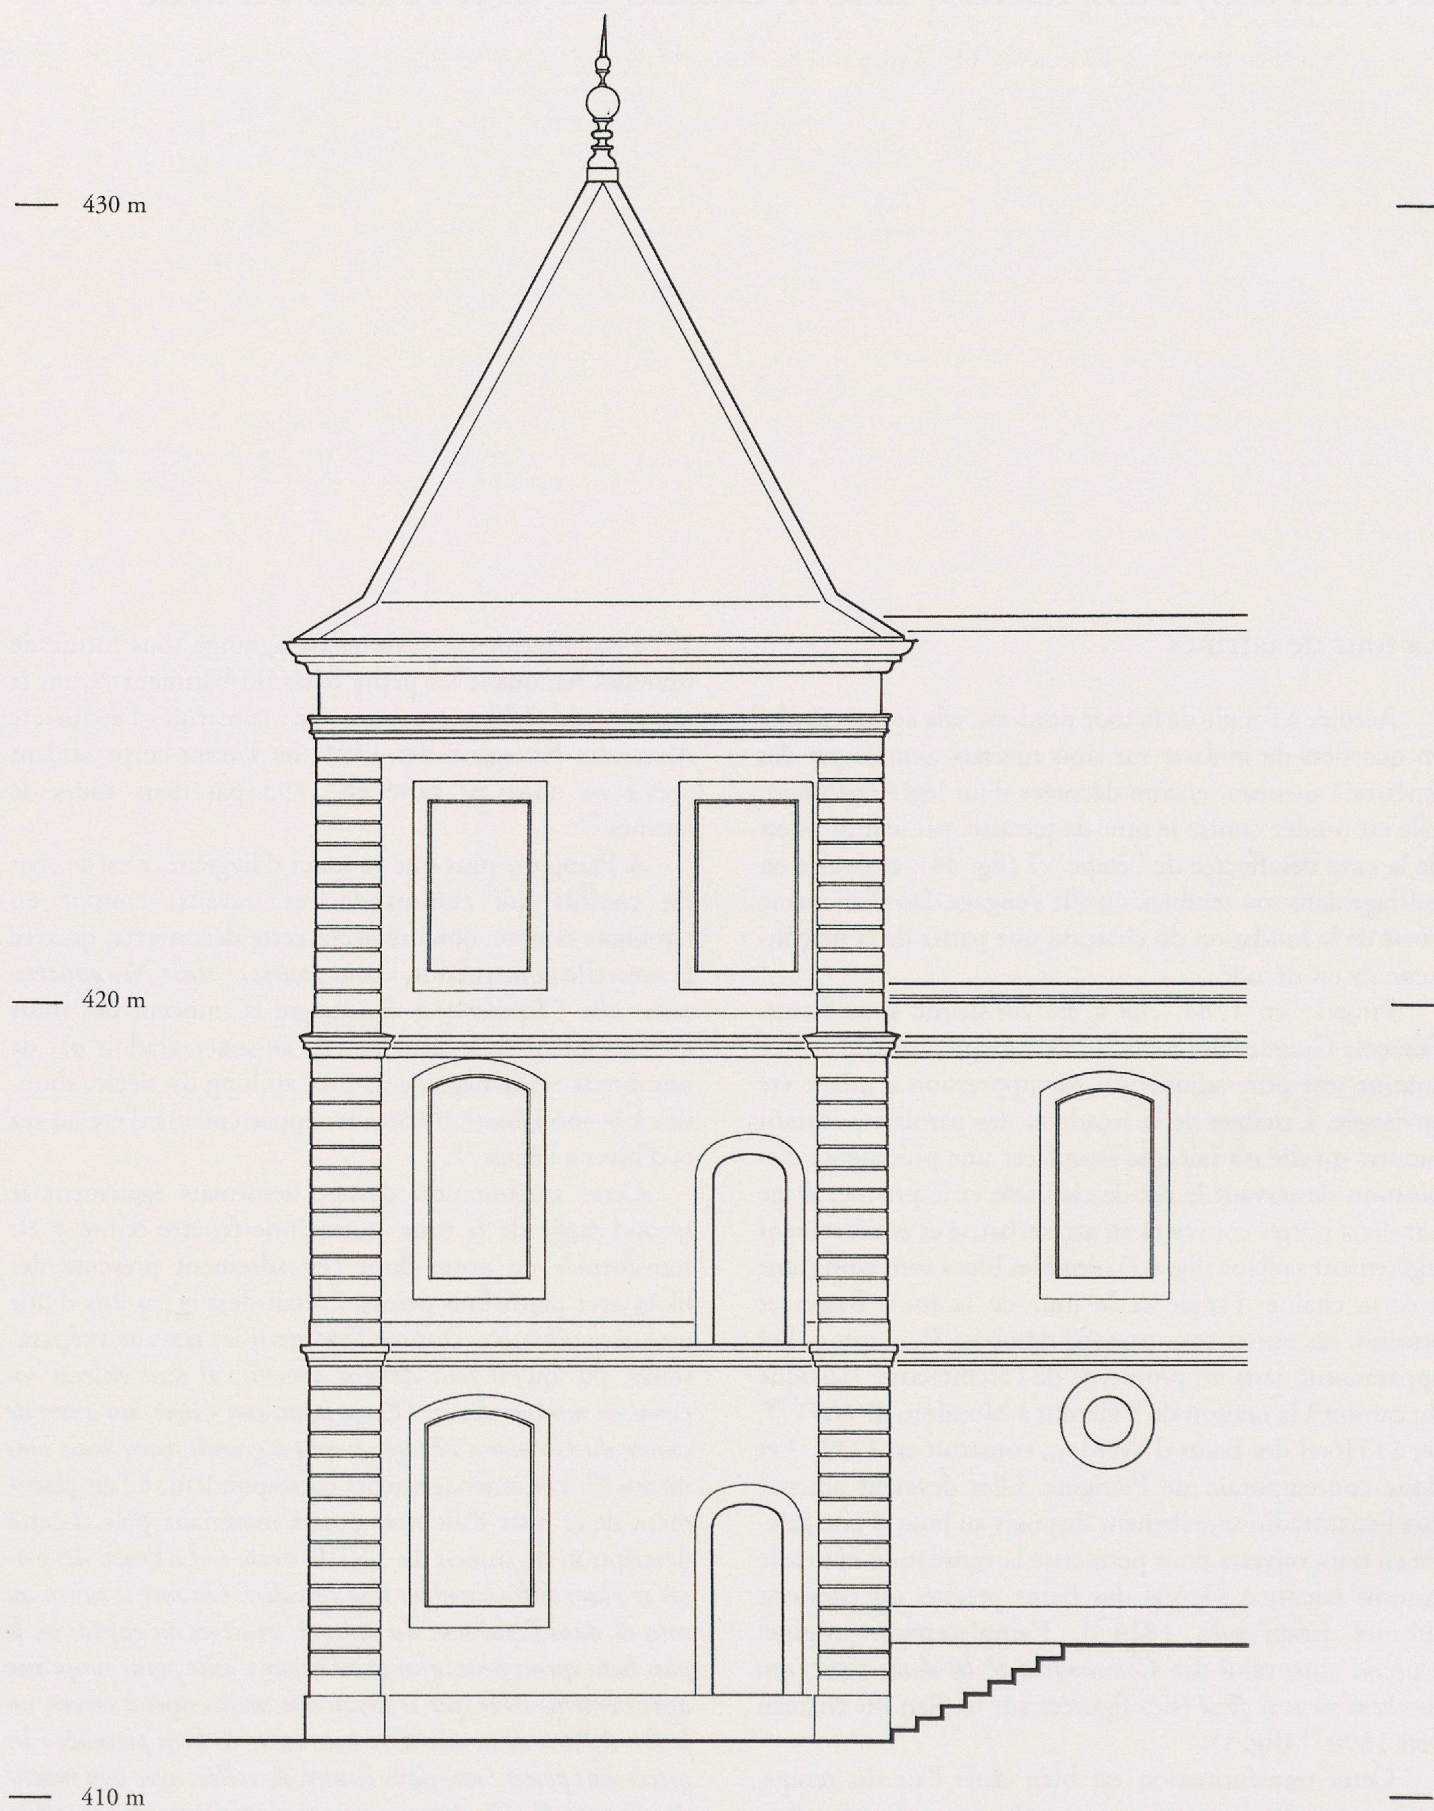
Restitution de la façade de la tour nord-est avant la construction de la tourelle de latrines, avec à rez-de-chaussée et au premier étage les portes d'accès au dispositif précédent (éch. 1:100).
